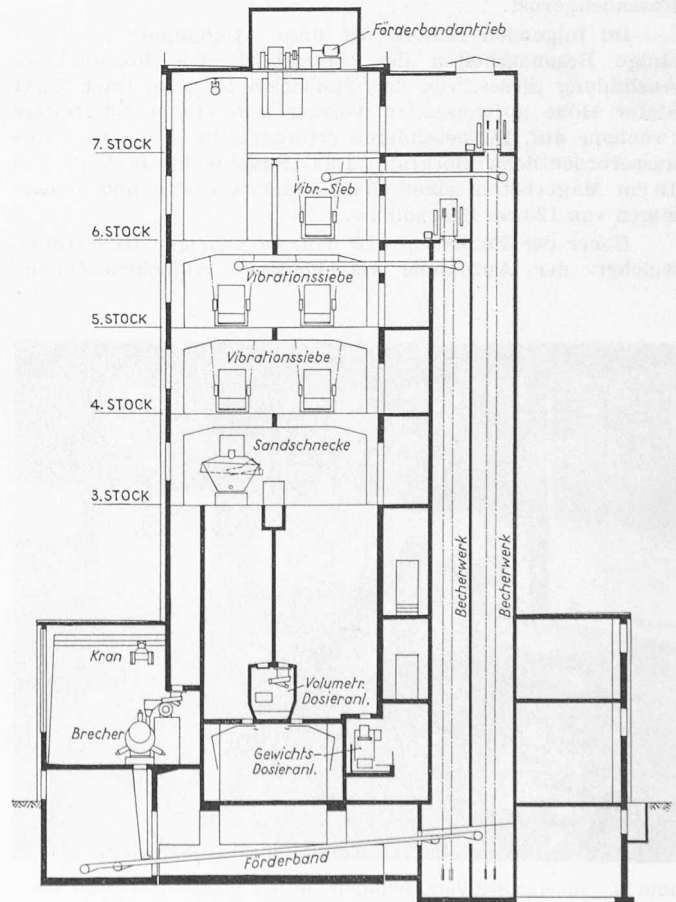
Querschnitt auf der Höhe der Becherwerkschächte und der Maschinen für die Aufbereitung der gebrochenen Komponenten
